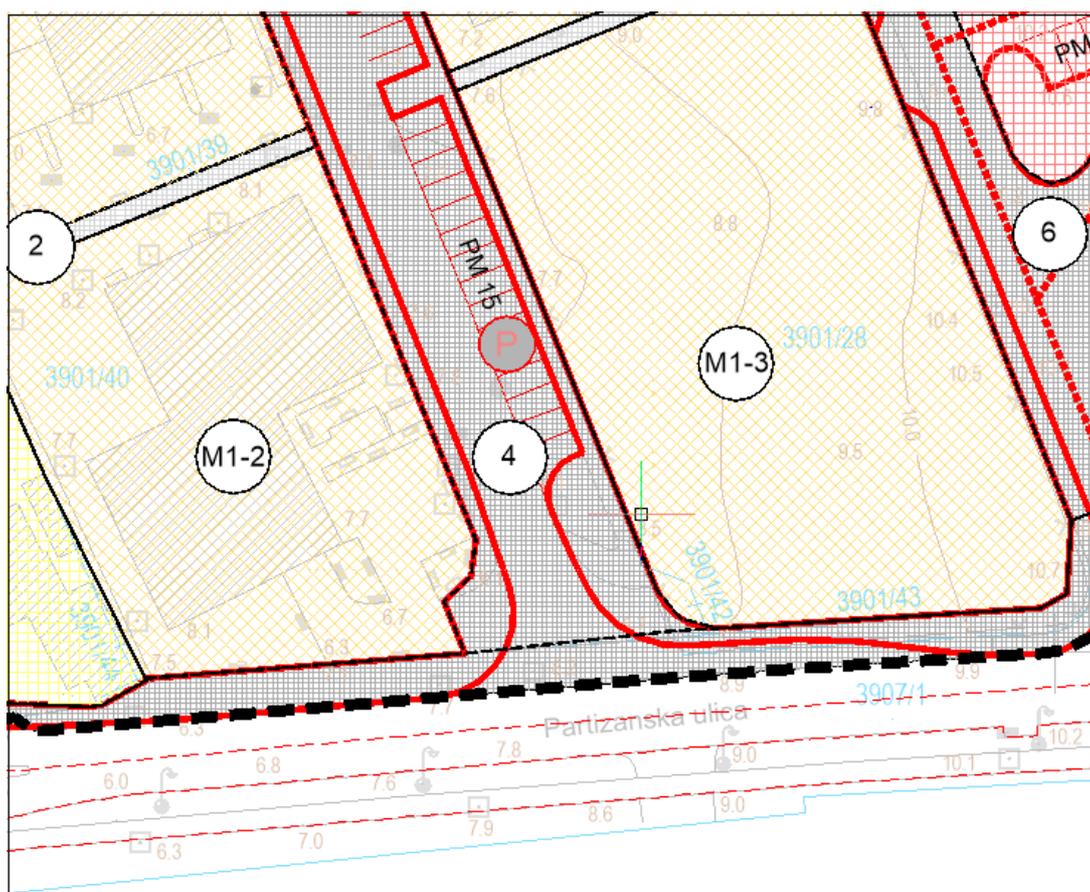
postojeće stanje prometa u slijepoj ulici izvedenoj prema važećem planu
